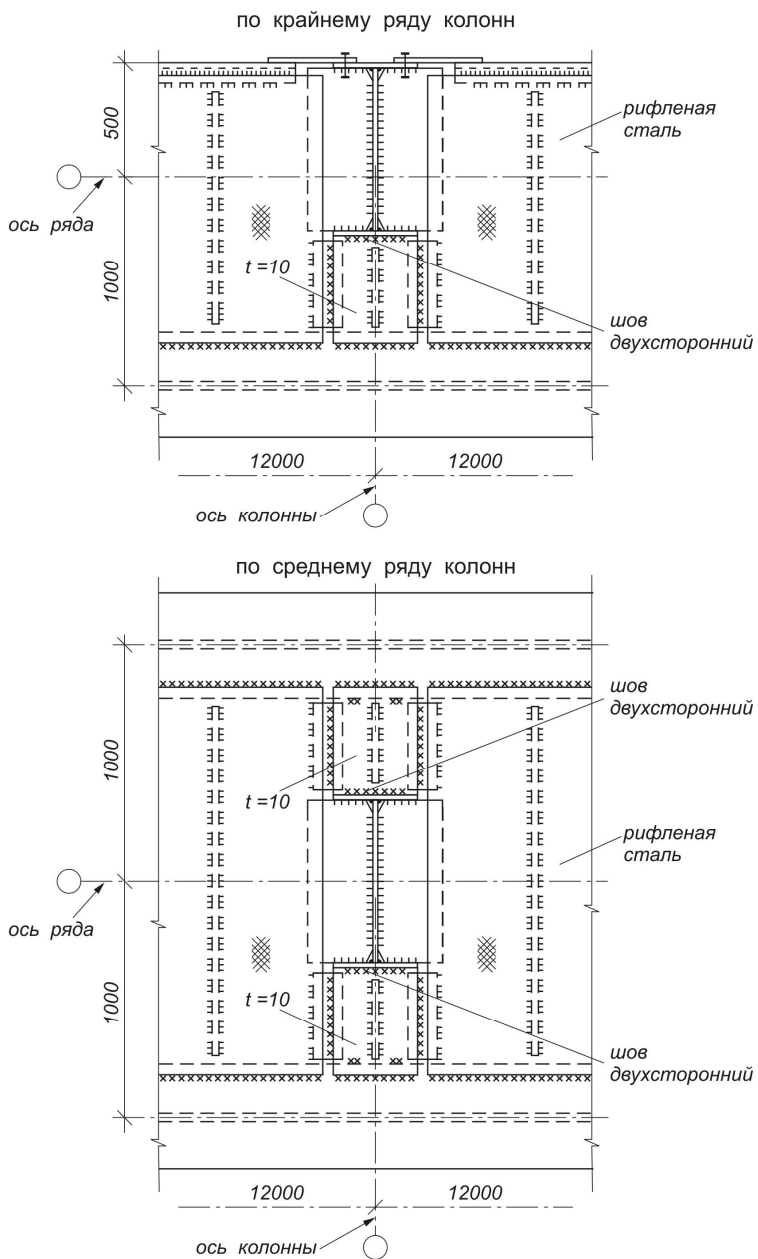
Сопряжение неразрезных подкрановых конструкций с колонной в уровне верхнего пояса балки
